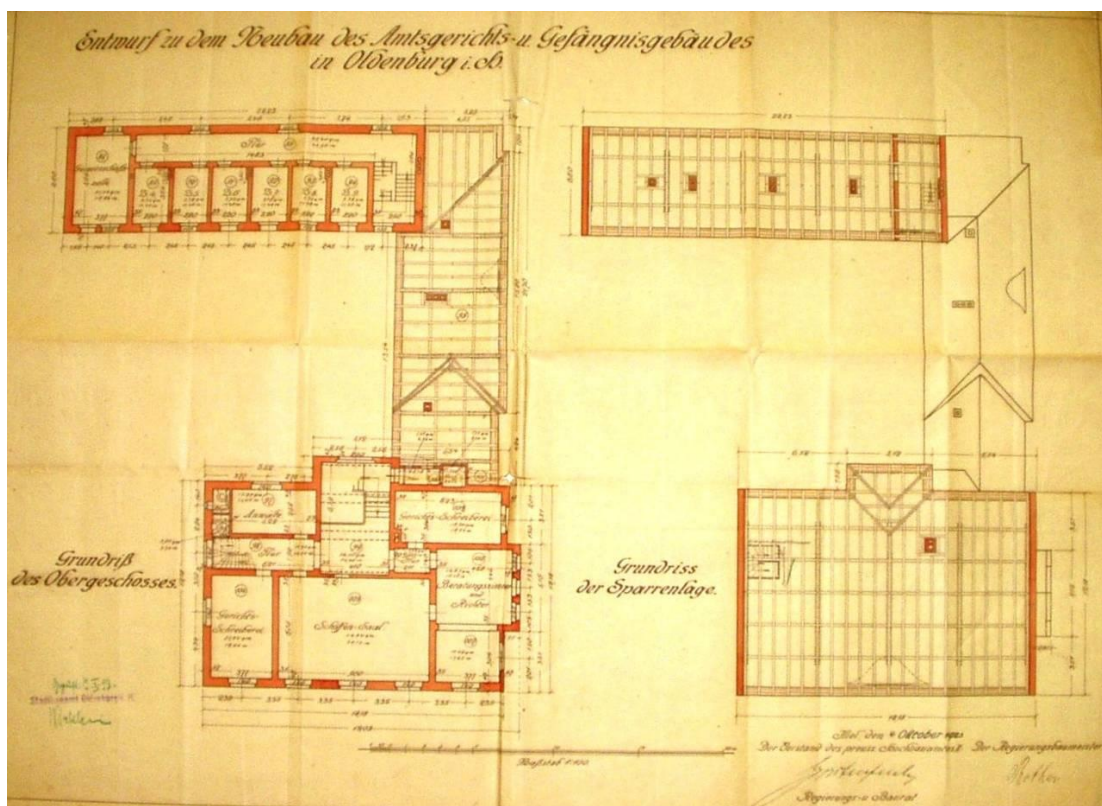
Amtsgericht in Oldenburg. Grundriß des Obergeschosses und der Sparrenlage.
